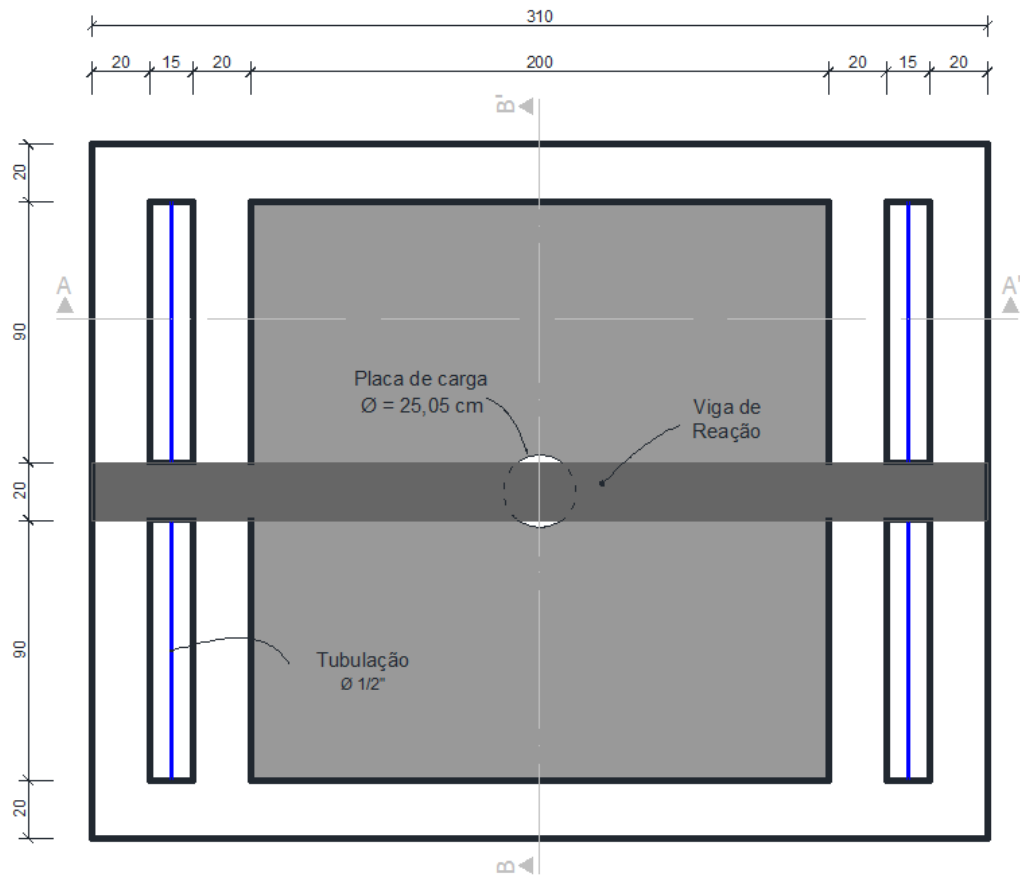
Planta Baixa do modelo físico – medidas em cm (s/ escala)
